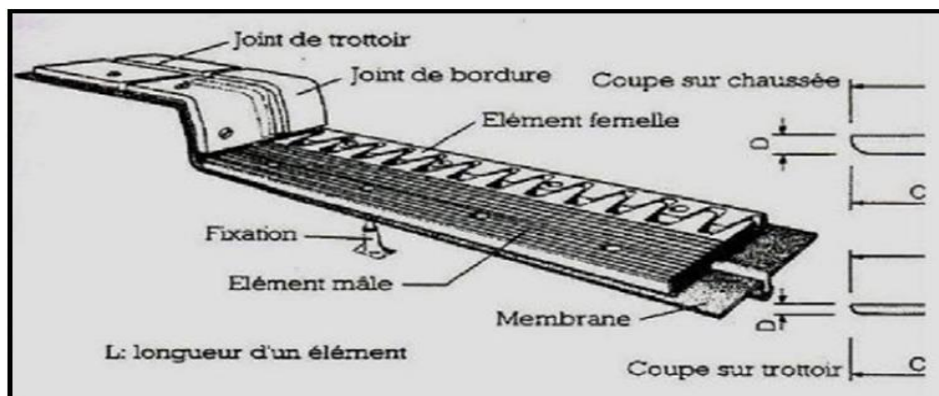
Les différents éléments d'un joint de chaussée.
